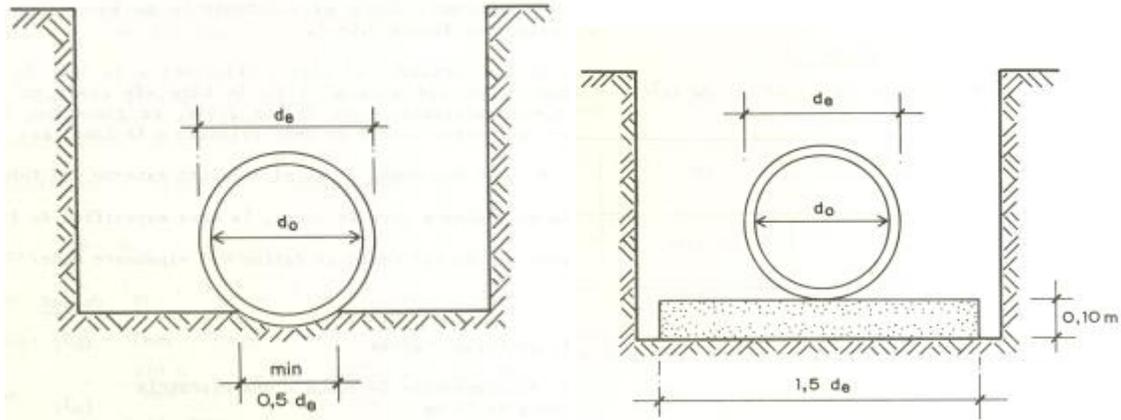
Cama de apoyo para asentamiento de tuberías
